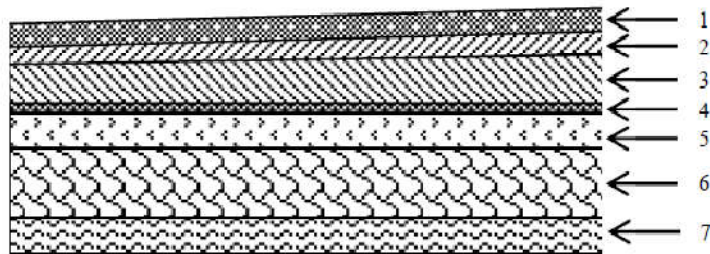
Coupe transversale du plancher terrasse inaccessible.
